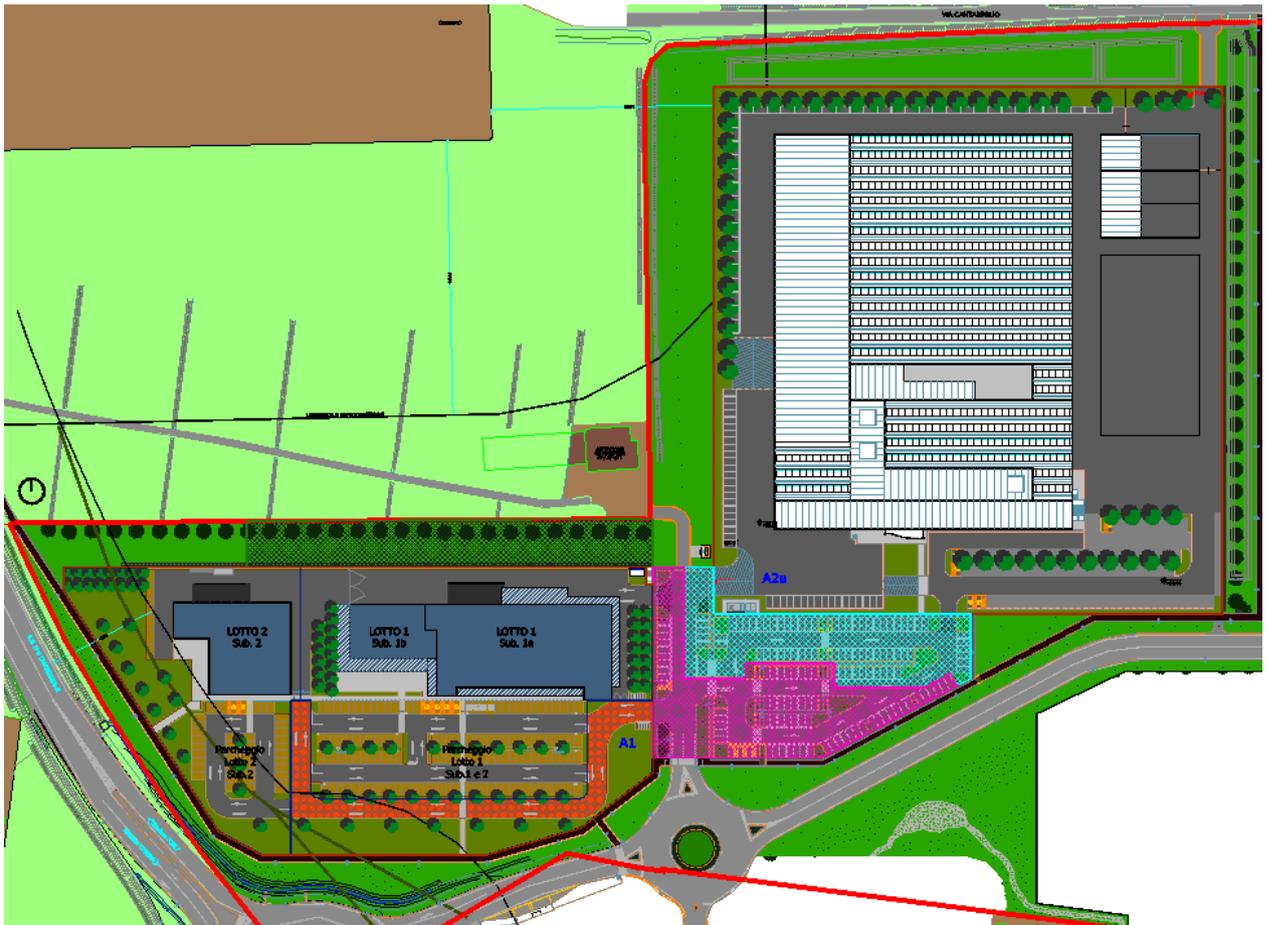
Planimetria dell'area di intervento (sub comparto A, lotto A1)
